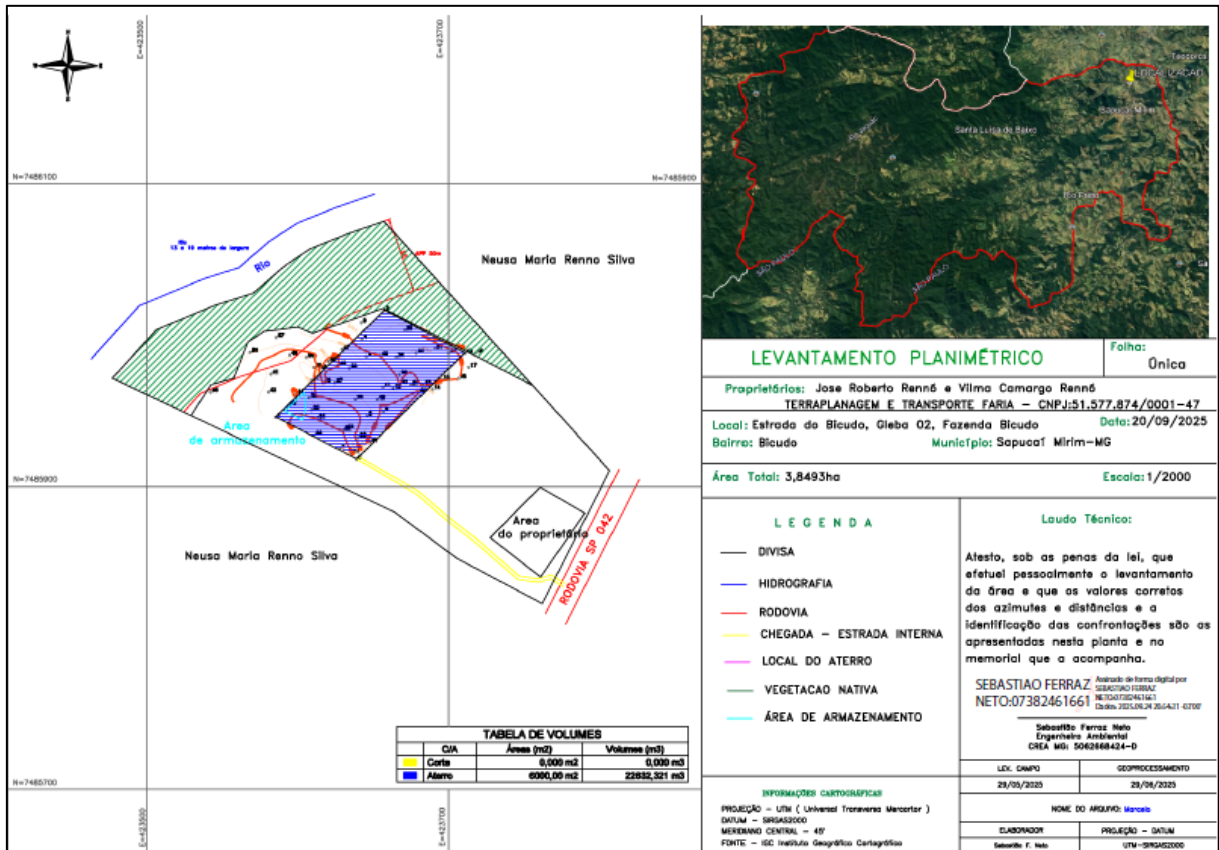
Layout* do empreendimento em planta. Fonte: PA SLA nº 49489/2025.
